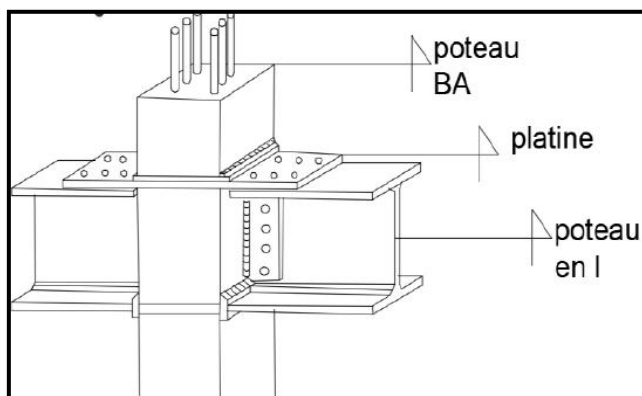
Détail d'une jonction d'un poteau en BA/ poutre métallique
